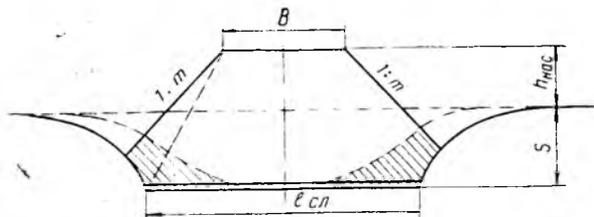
Очертание подошвы насыпи на слани и прилегающих участков болота (пунктиром показано очертание насыпи без слани)
